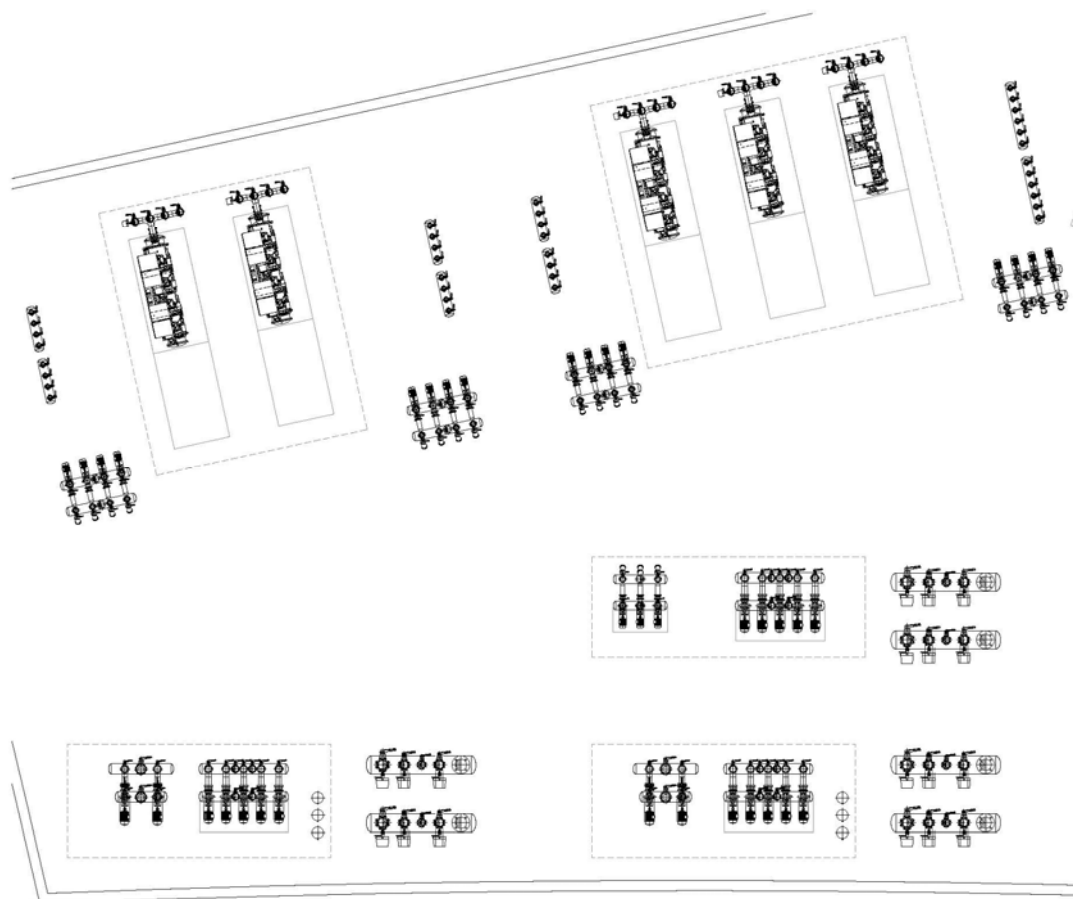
Stralcio planimetrico Layout Energy Centre
